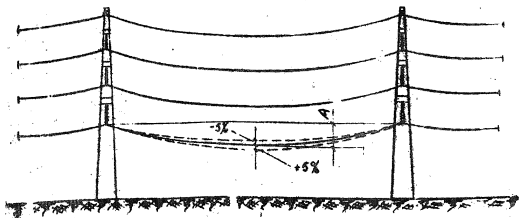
Нормы и допуски на монтаж проводов.
